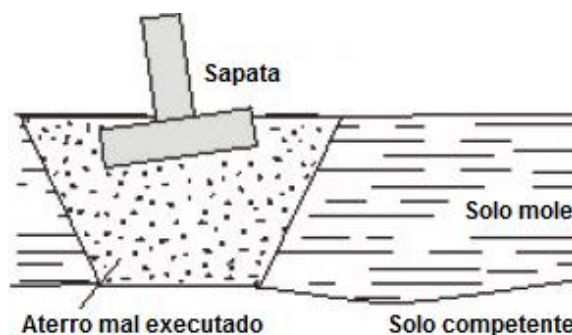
Fundação assente sobre um aterro mal executado [90]
